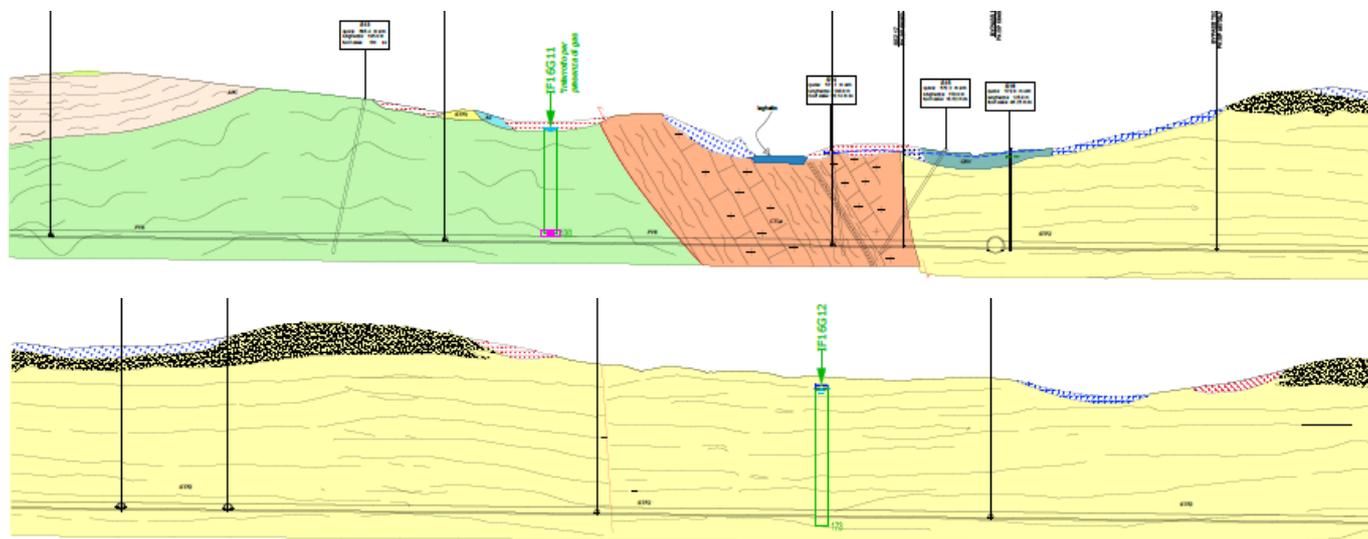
Profilo di previsione tra le pk 55+600 e 57+600.
